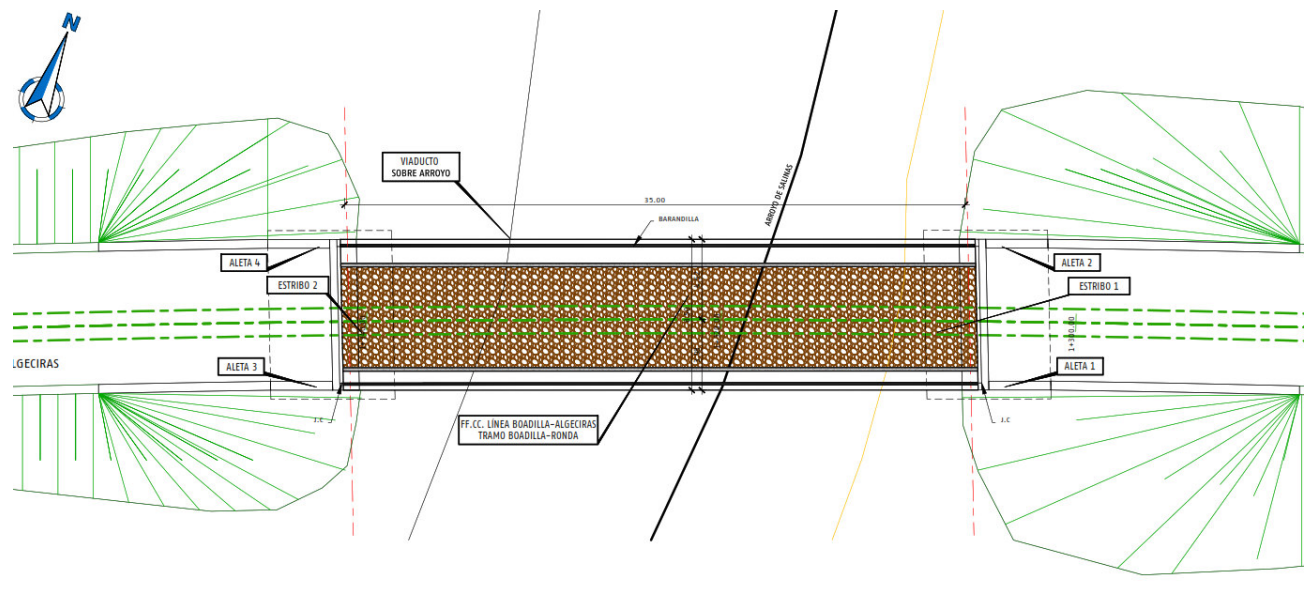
Planta Vdto. Arroyo de las Salinas.
